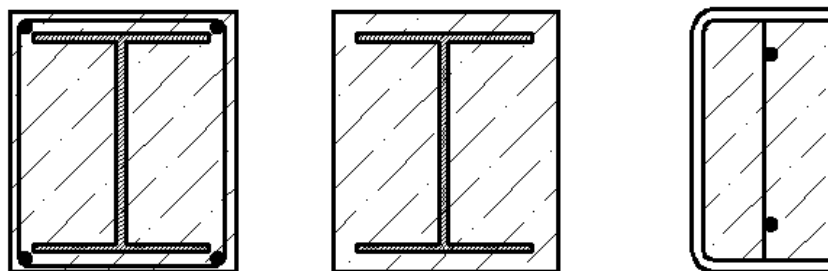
Сталезалізобетонні конструкції, що складаються з жорстких сталевих профілей та розташовуються в середині залізобетонної частини конструкції – залізобетонні конструкції з жорсткою арматурою.
